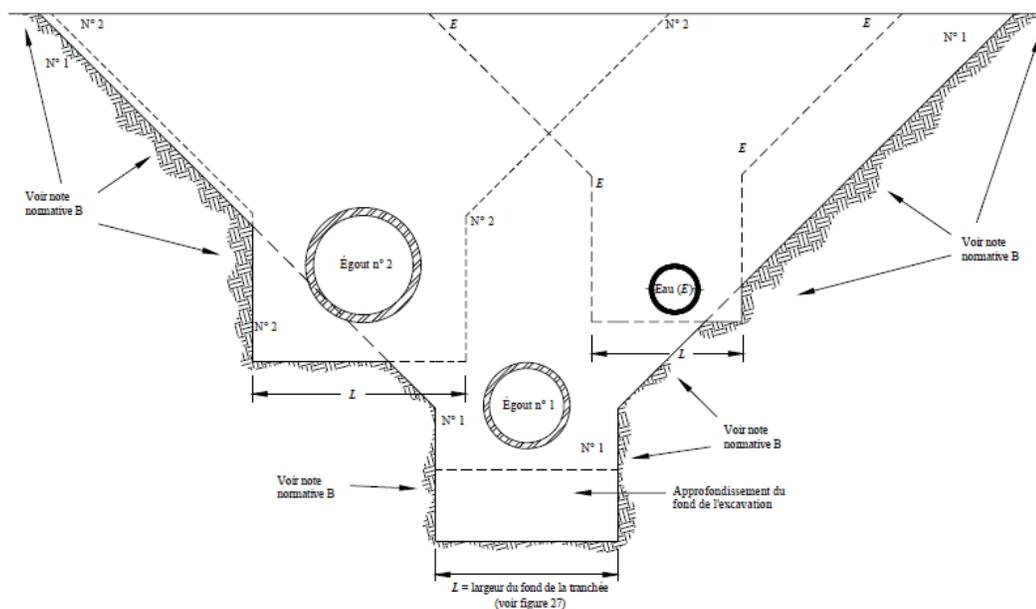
Extrait Figure 32 du BNQ 1809-300 : Section type d'une tranchée commune
